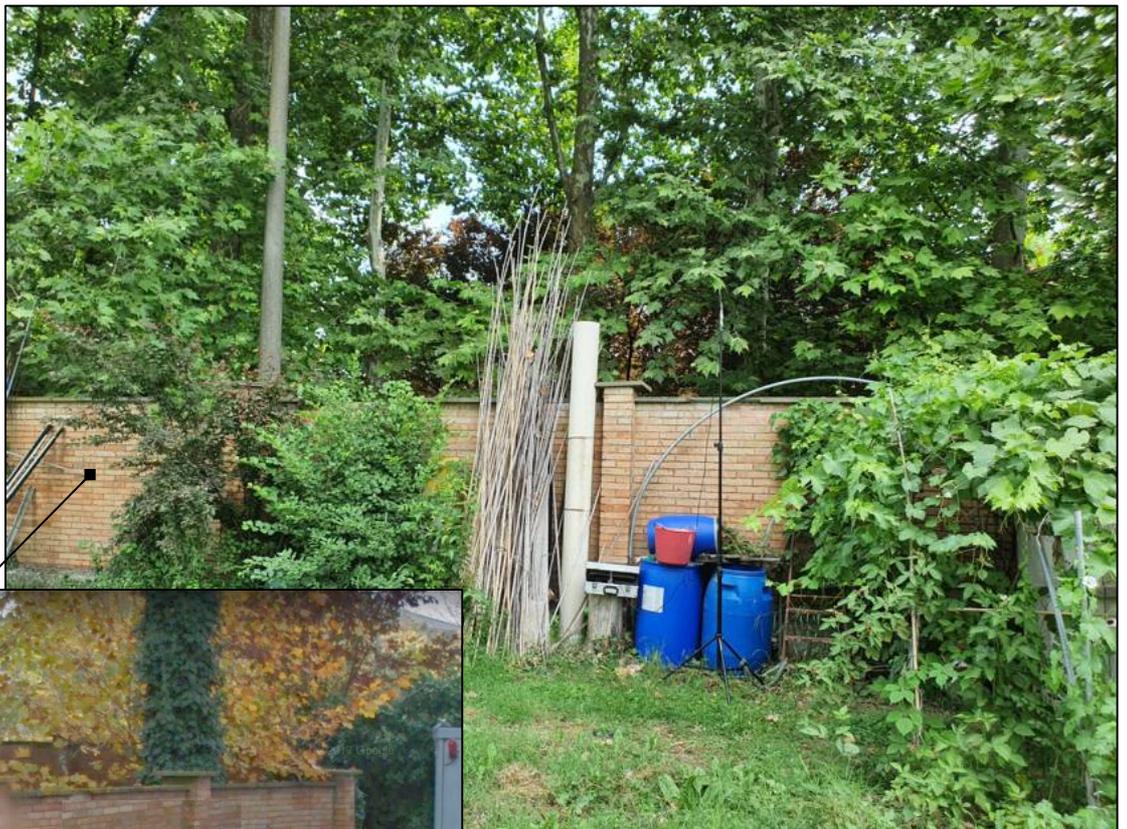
Foto dell'alto muro che separa dall'area dal lotto residenziale adiacente: su tutto il perimetro lato orti è alto almeno 2 m
